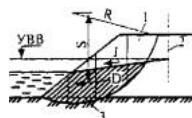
Схема к расчету устойчивости откосов подтопляемой насыпи:
